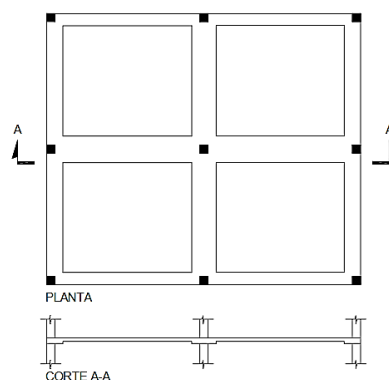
Laje com viga faixa (EMERICK, 2005).
